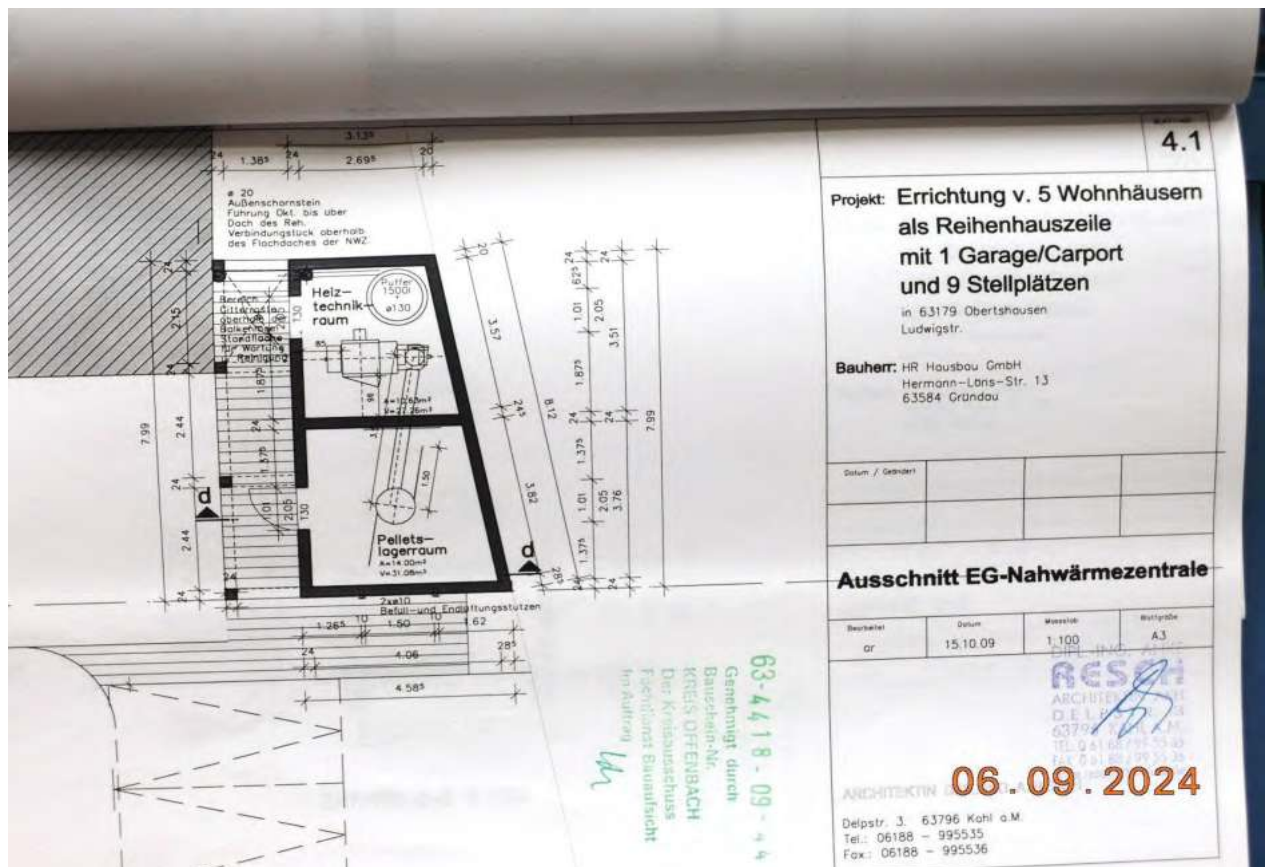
Grundrissplan Erdgeschoss der Nahwärmezentrale (aus Bauakte)
